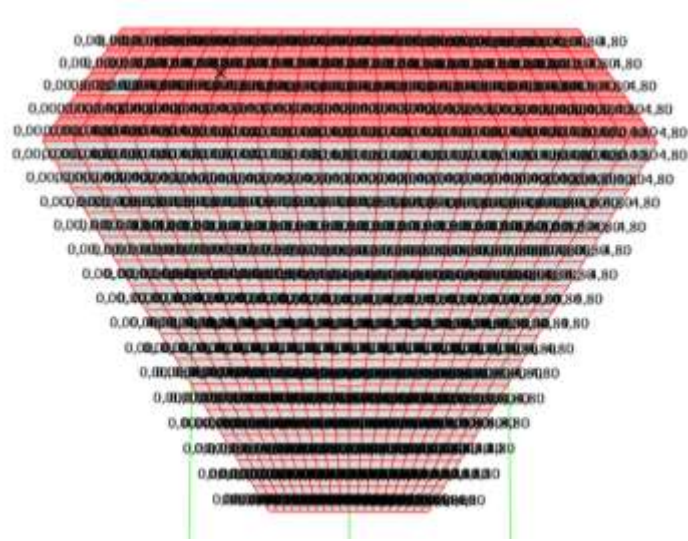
Beban Pemeliharaan (ML) yang diterima Struktur *Catwalk 14
